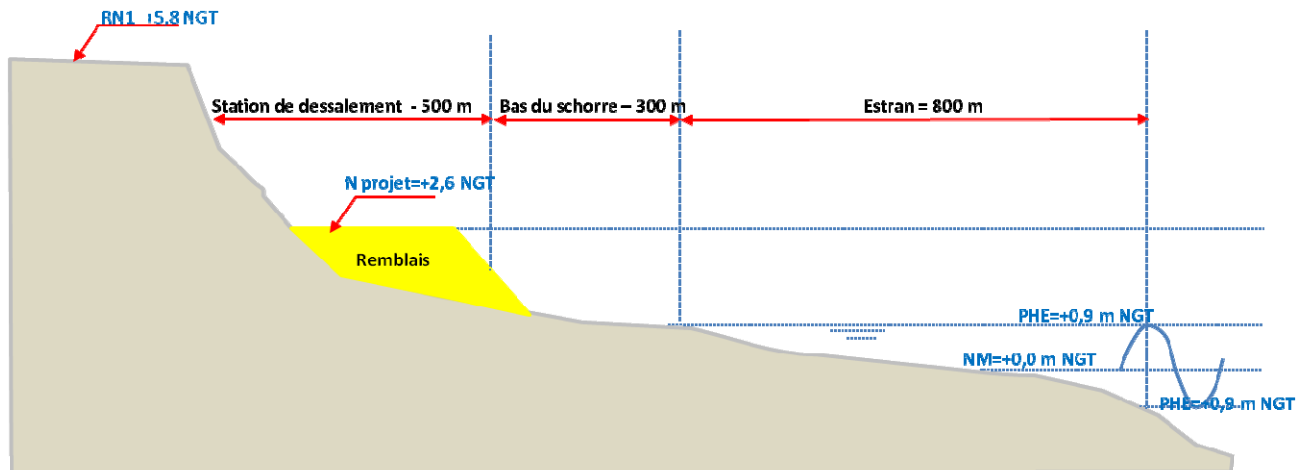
Remblais prévu au niveau du site de la station de dessalement
